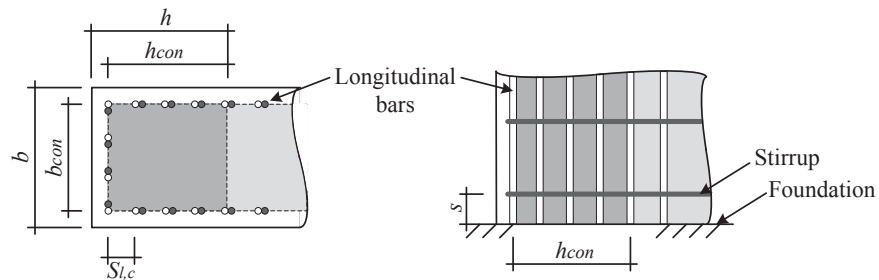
Marge considérée pour la détermination de la limite d'allongement de piles avec recouvrement d'armature longitudinale.
